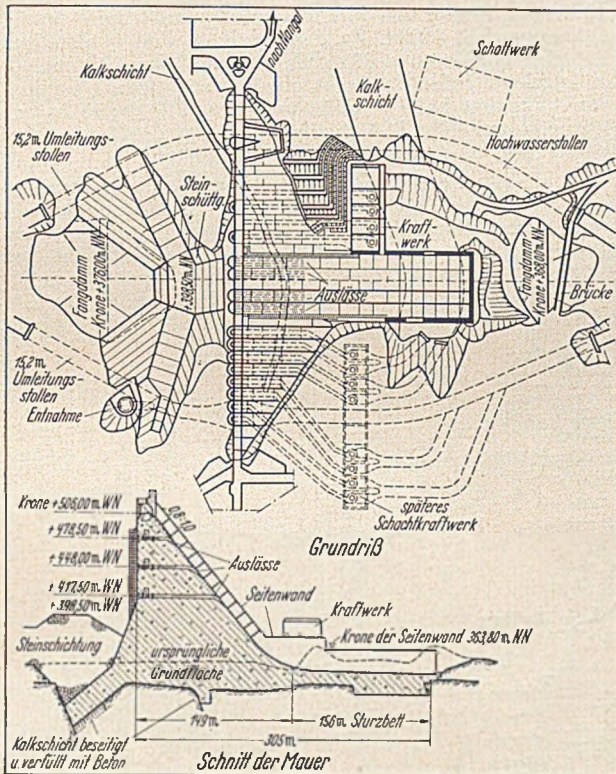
Grundriß und Querschnitt der Bhakra-Staumauer.
